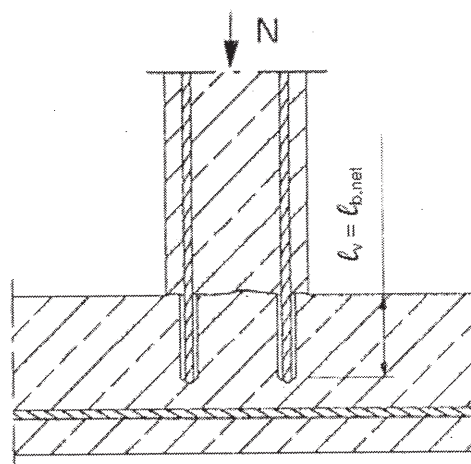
Połączenie na zakład przy fundamencie ściany lub kolumny, gdzie pręt zbrojeniowy poddawany jest działaniu naprężeń.
